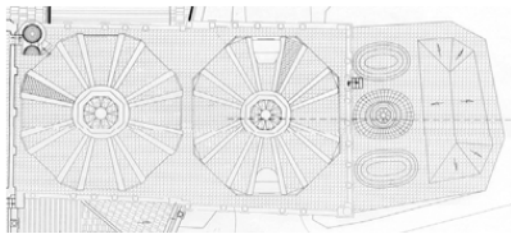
Quito, Compañía de Jesús church, detail of roof plan, transept and presbytery domes (IMP 1995).
